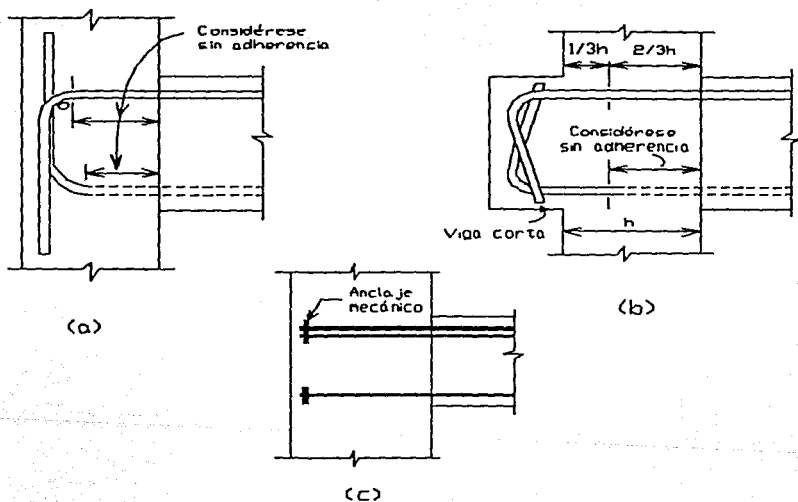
Anclaje de varillas de viga en columnas utilizando, a) varillas dobladas hacia arriba; b) Varillas dobladas hacia arriba en la extensión; c) Anclaje mecánico. (1.1)
